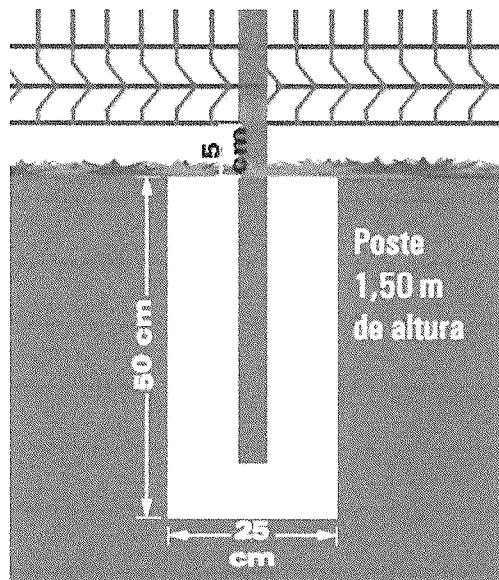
Ilustração de poste de gradil chumbado em concreto.
